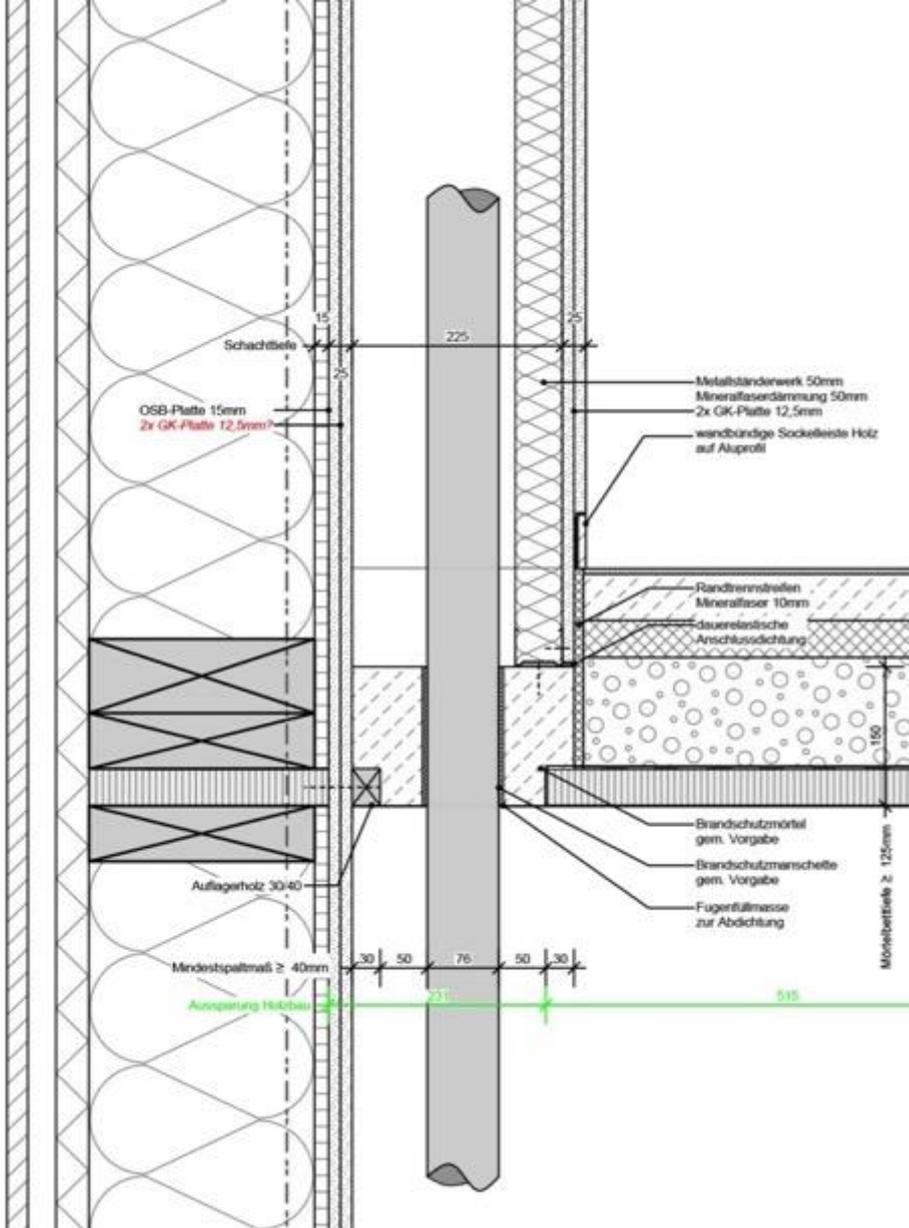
Nasseinbau in Holzbalkendecke bis EI 90 S, stehend (Abbildung stellvertretend, andere Aufbauten auf Anfrage)
